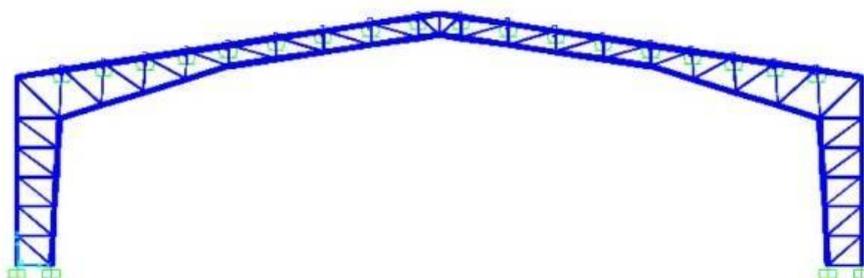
Geometría Propuesta B Fuente: Los autores.
